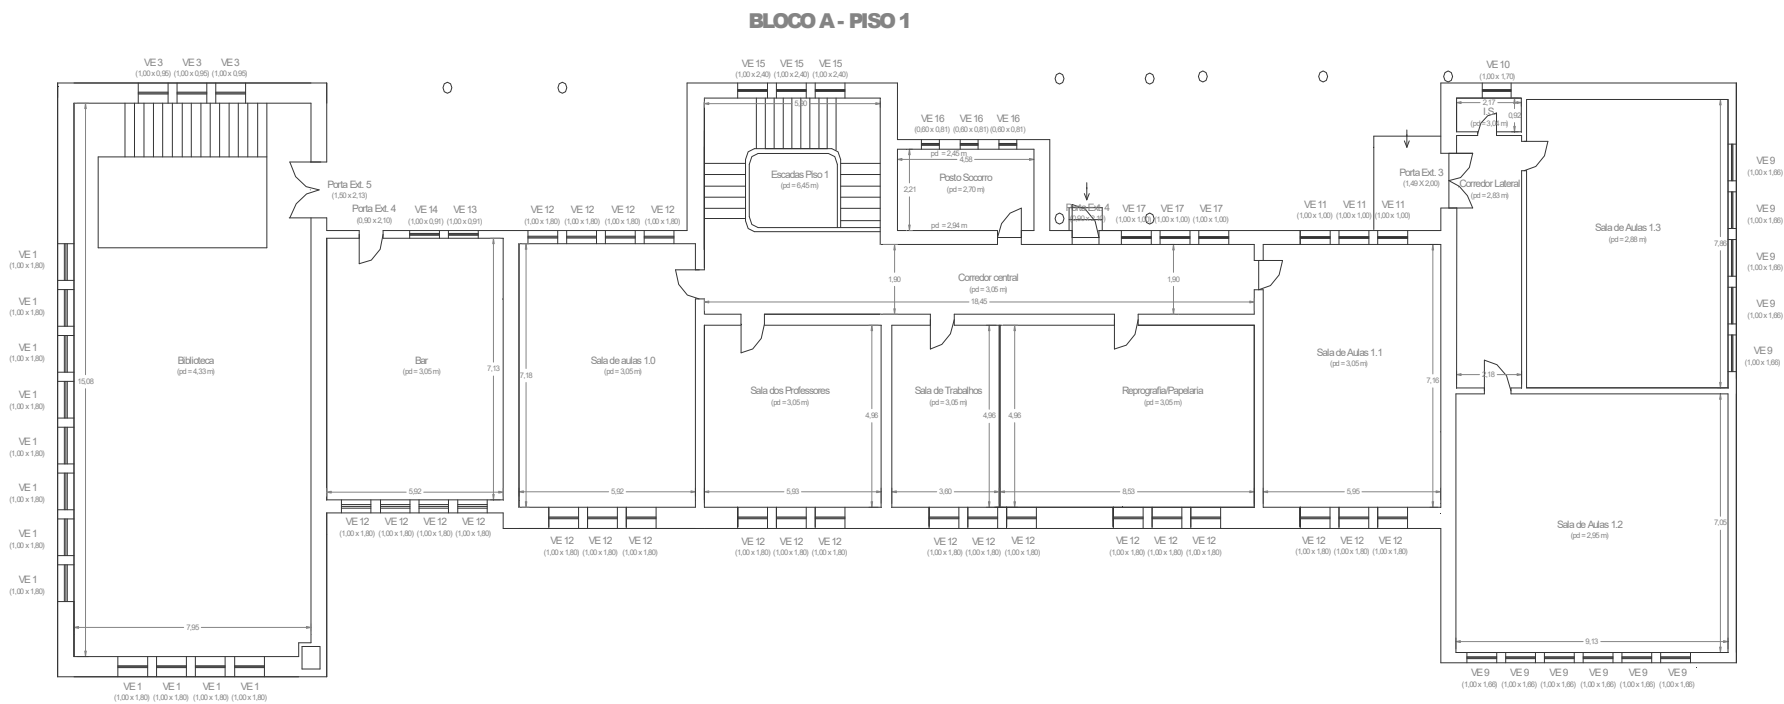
Desenho 2D do levantamento dimensional e geométrico do Piso 1 do Bloco A.
